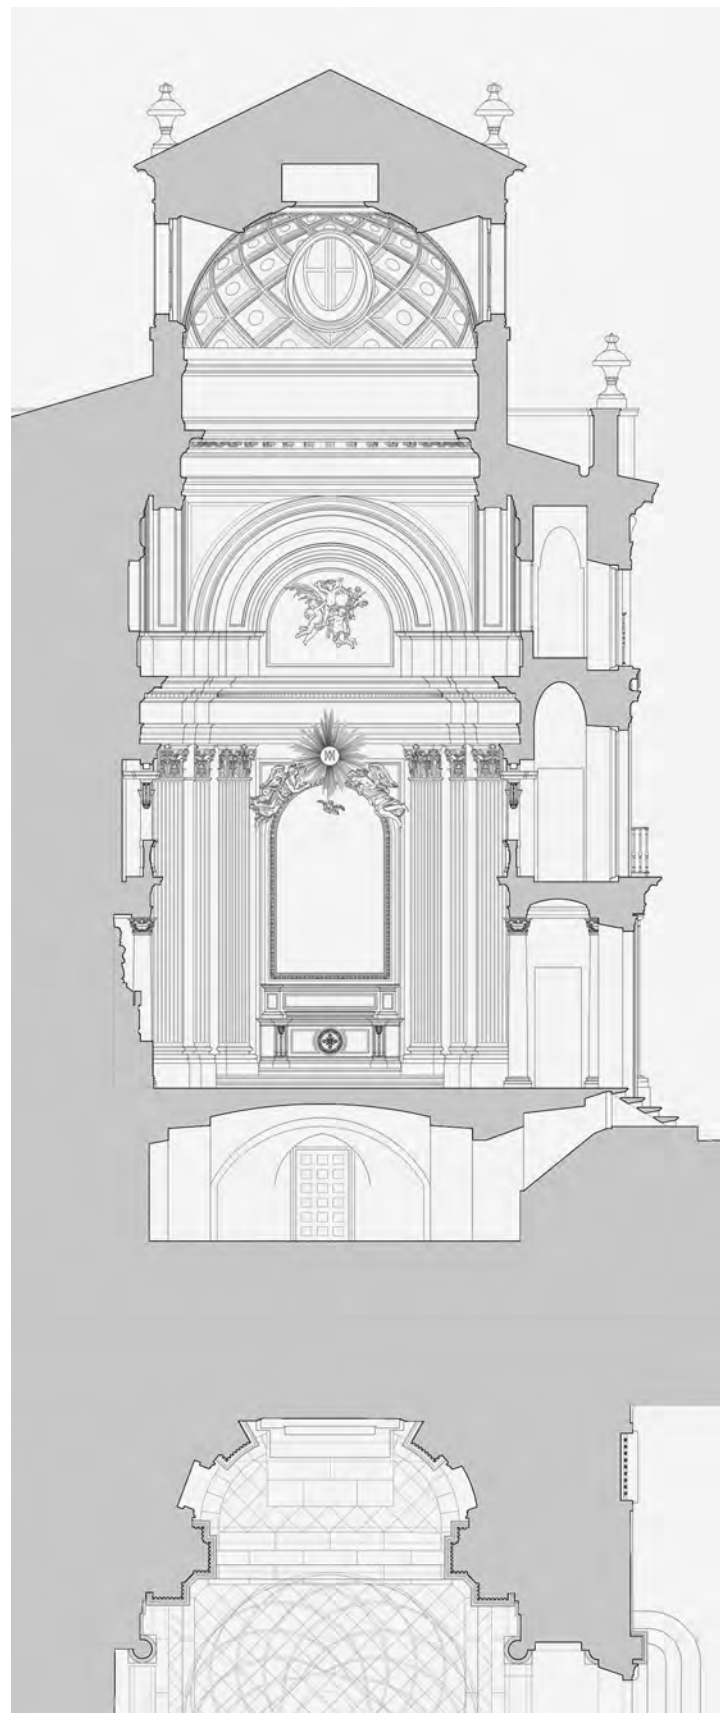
Capilla del Palacio de Boadilla del Monte, sección transversal y planta. E.T.S.A.M., 1999, dirigido por Javier Ortega et alii
